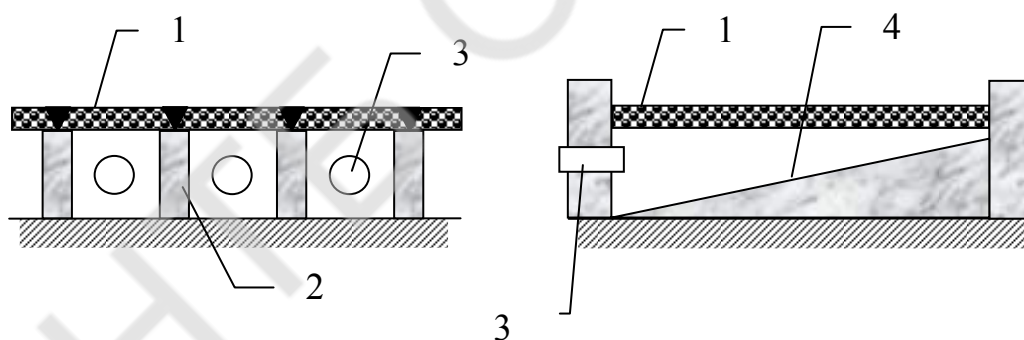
Схема нижнего полимербетонного дренажа: 1 – полимербетонная плита; 2 – опорная бетонная стенка; 3 – патрубок большого сопротивления; 4 – набетонка.
